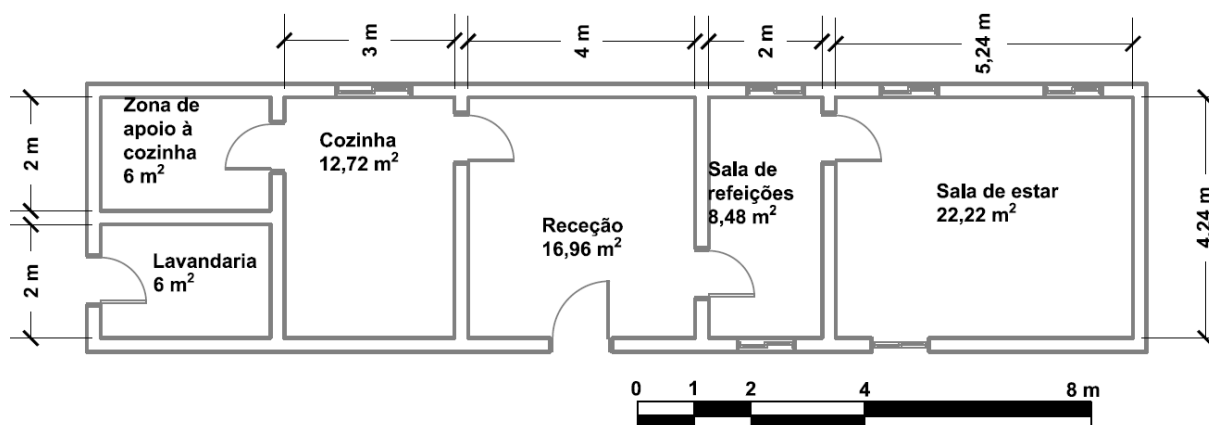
Planta do edifício da recepção, zona da cozinha, lavandaria e zona de pequeno-almoço e sala-de-estar.
